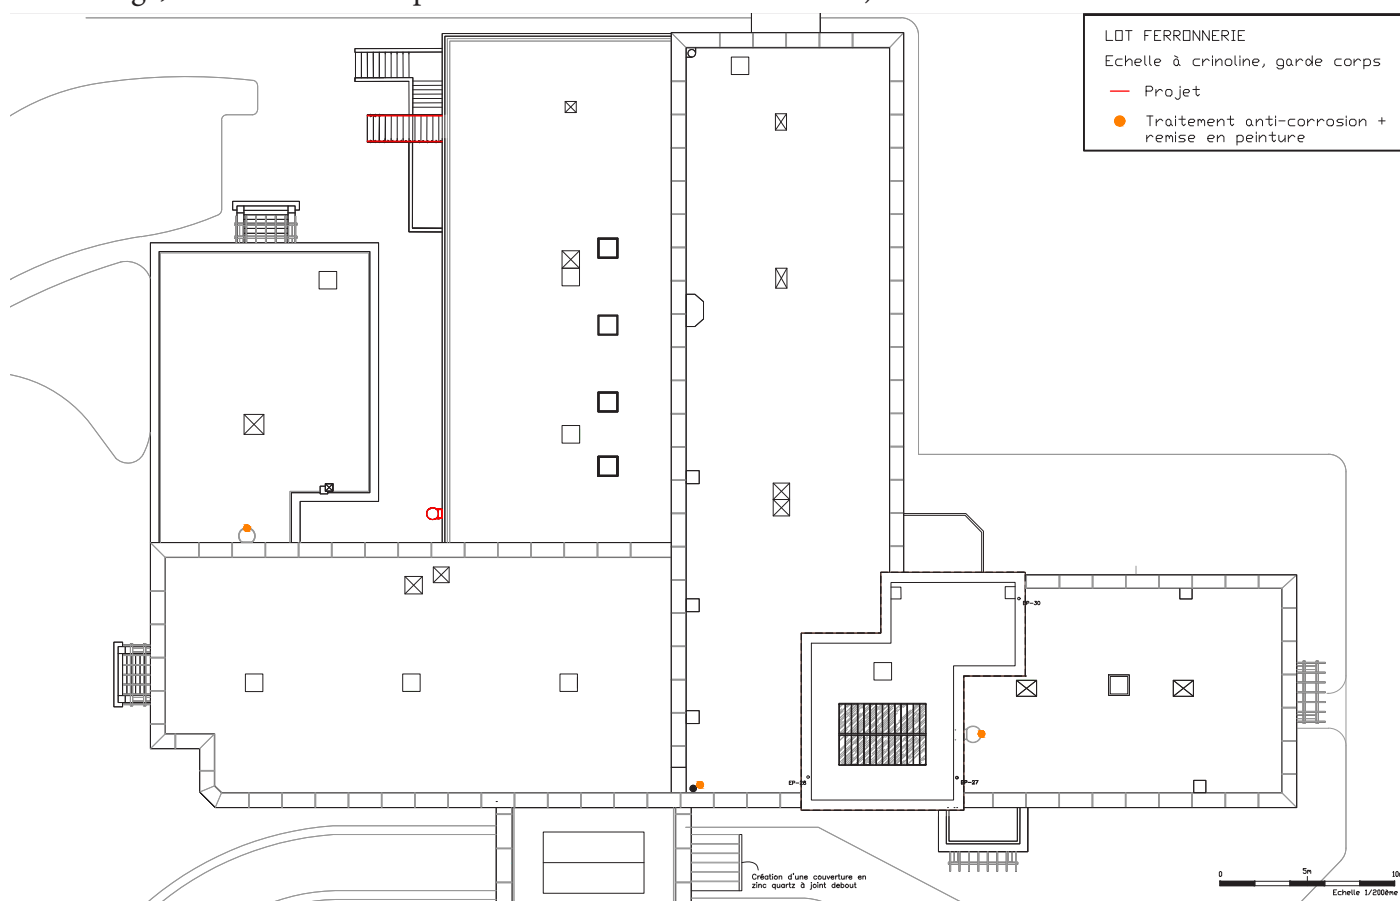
État projeté (APD) du lot ferronnerie-serrurerie, plan des toitures, pavillon A, Agence Goutal, 2024.
